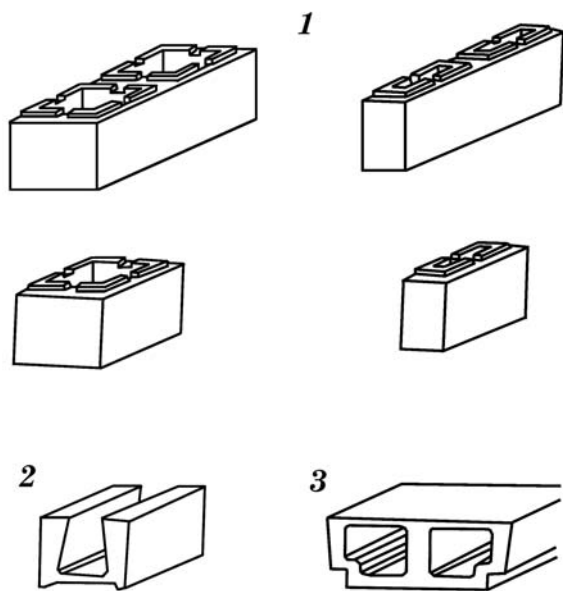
Основные виды мелкогабаритных камней: 1 – камни для стен и перегородок; 2 – перемычный камень; 3 – камень для перекрытий (вес камней от 10 до 16 кг)
